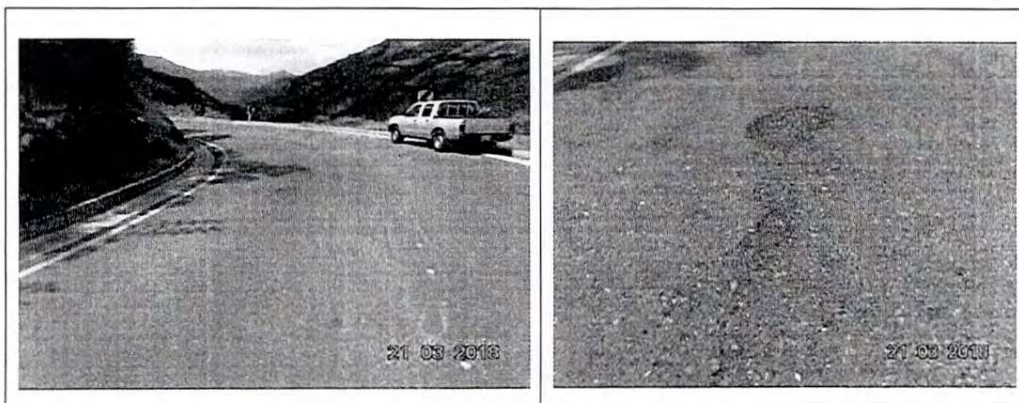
PR18+980 (4): Pérdida de rodadura (carril izquierdo)
